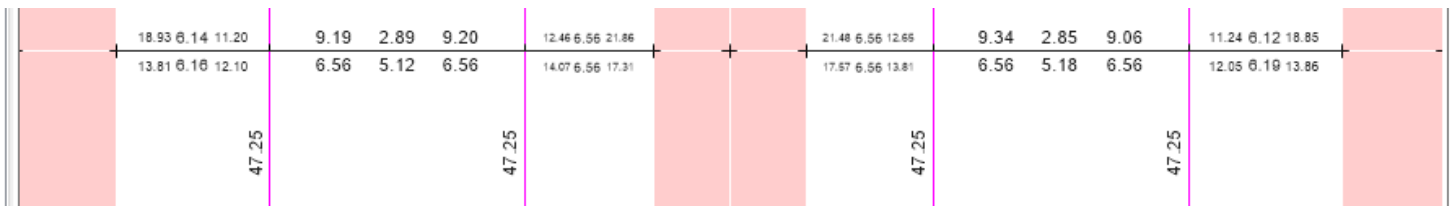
Acero Requerido por momentos en Vigas 2° Piso
